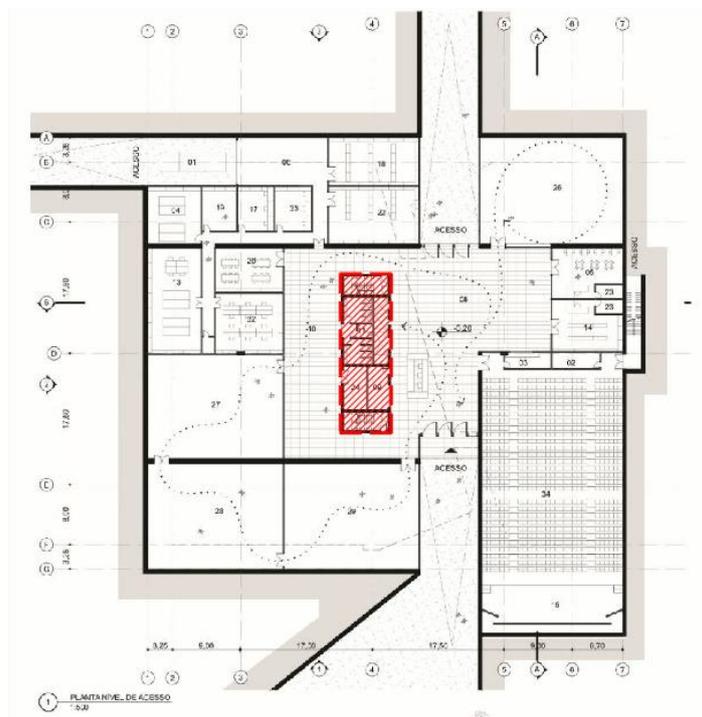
Planta Baixa nível de acesso, evidenciando únicos meios de circulação entre pavimentos, orla_p006
